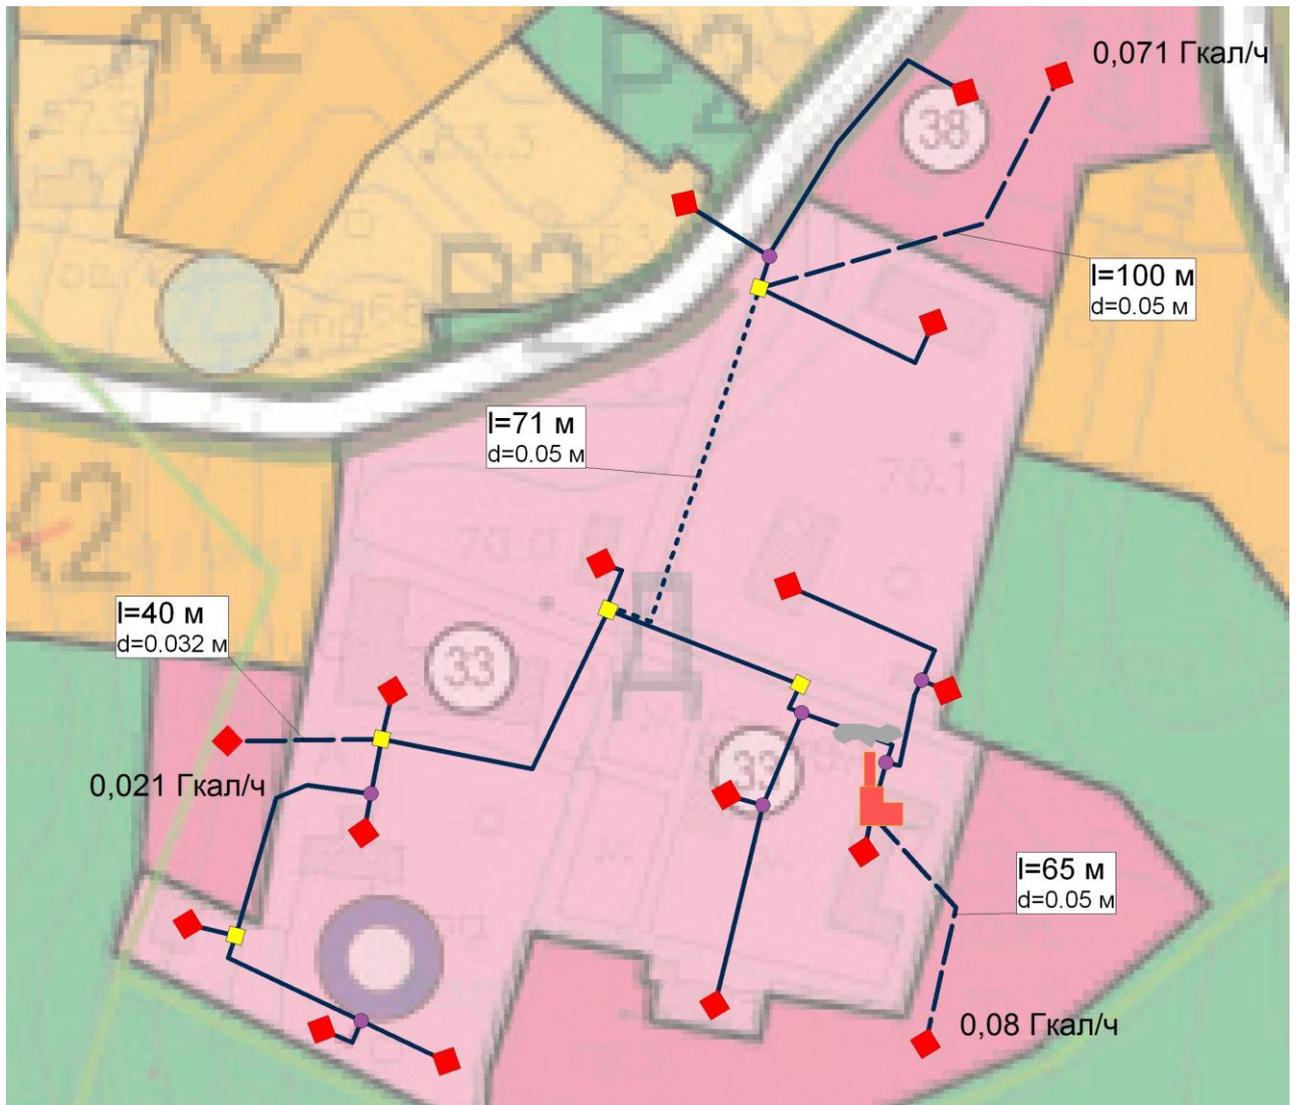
Строительство и реконструкция сетей к 2017 году (вариант 1).
